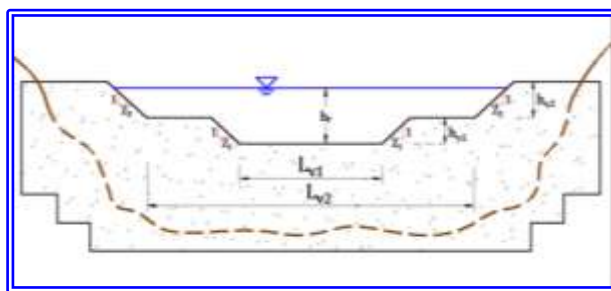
Sección típica de un vertedero de sección compuesta en una estructura de retención de sedimentos.- (Imagen del Autor).
